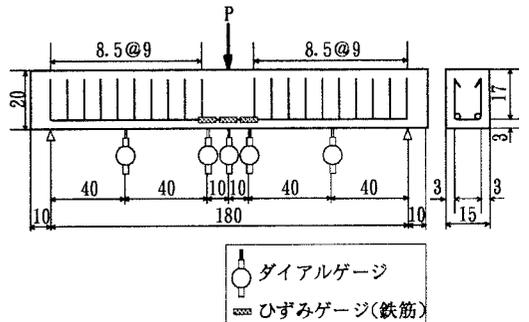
鉄筋コンクリート梁の寸法・形状およびひずみゲージ・ダイヤルゲージの配置(単位;cm)
